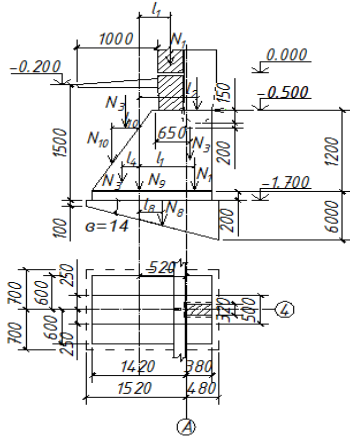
Примеры конструирования фундаментов для зданий с распором:
